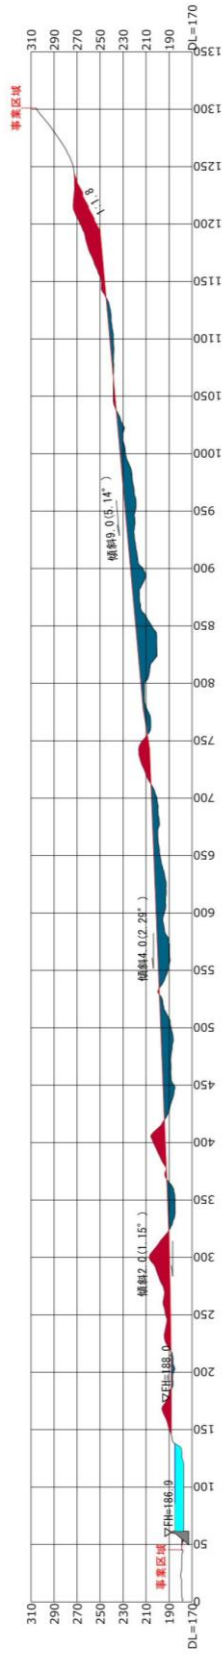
(4) 切土・盛土計画断面図 (E4-E4' 断面)
